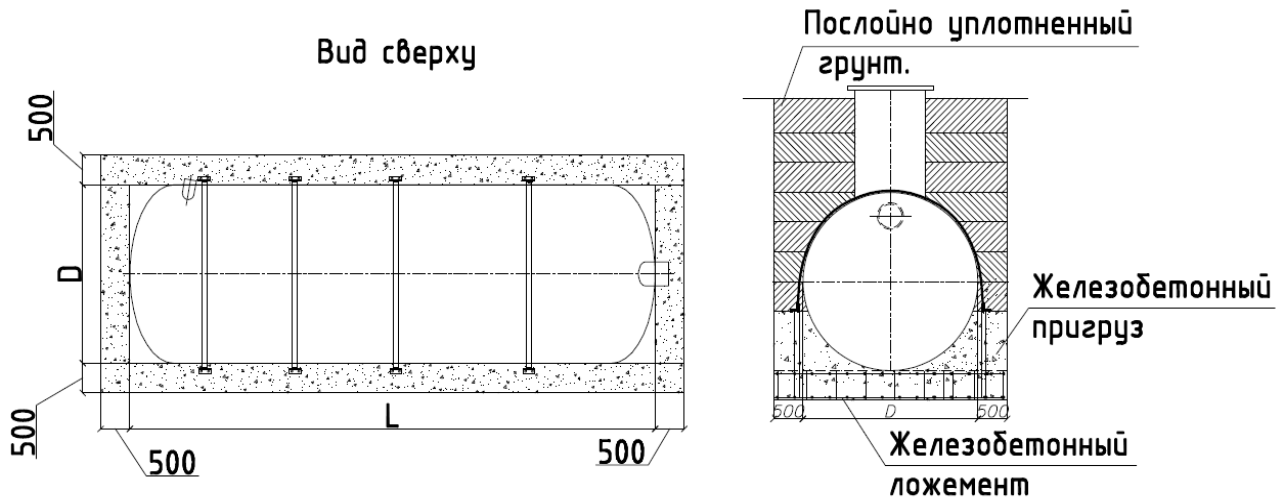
Пример монтажа оборудования при высоком уровне грунтовых вод
